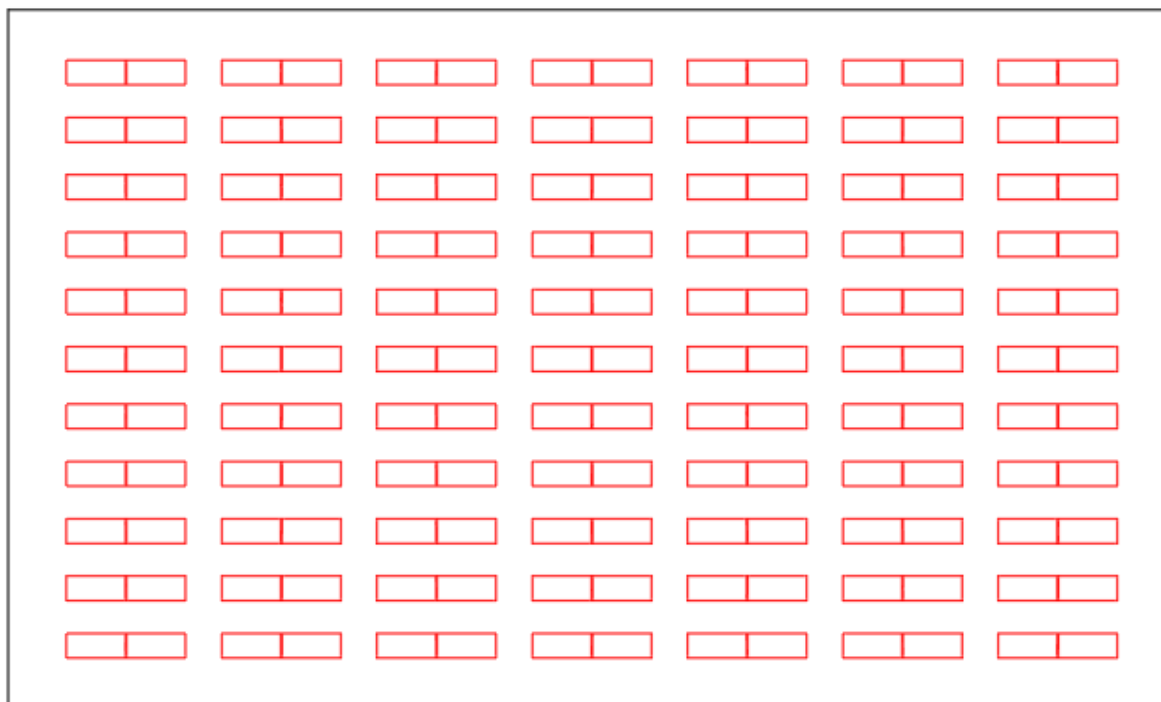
Disposición de los paneles (vista planta). [Elaboración propia]
